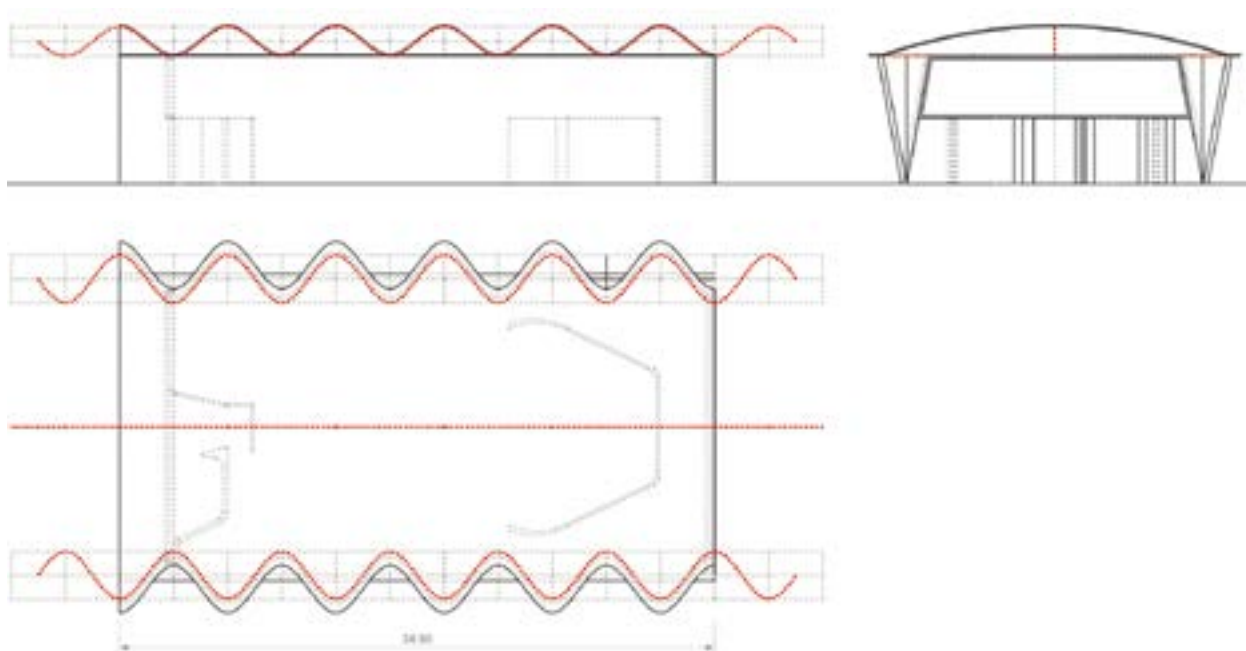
Esquema de alzados y planta, iglesia del Cristo Obrero, Eladio Dieste, 1960. Las curvas sinusoides se apoyan en los bordes superiores de los muros laterales y se levanta en el plano central de la nave. Es un proyecto que propone un prisma recto sobre el que se realizan unas operaciones de dinamización de sus planos, convirtiéndolos en superficies curvas. Dibujo de los autores.
